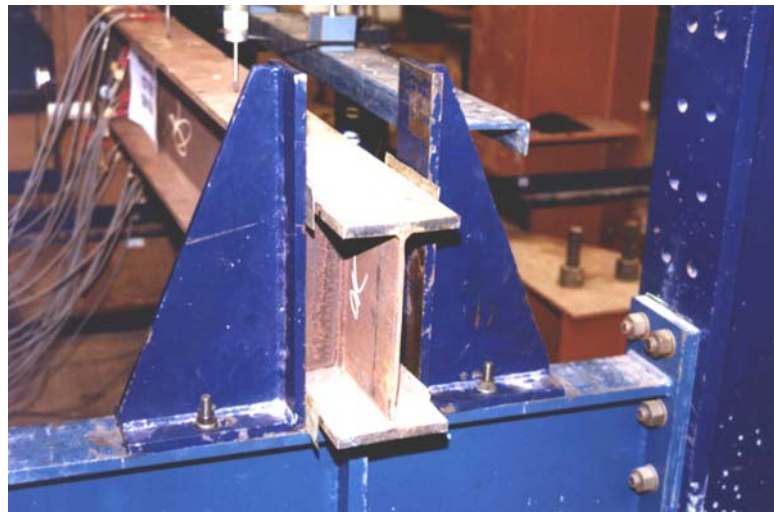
Chapas lubrificadas colocadas entre as mesas das vigas e os consolos
